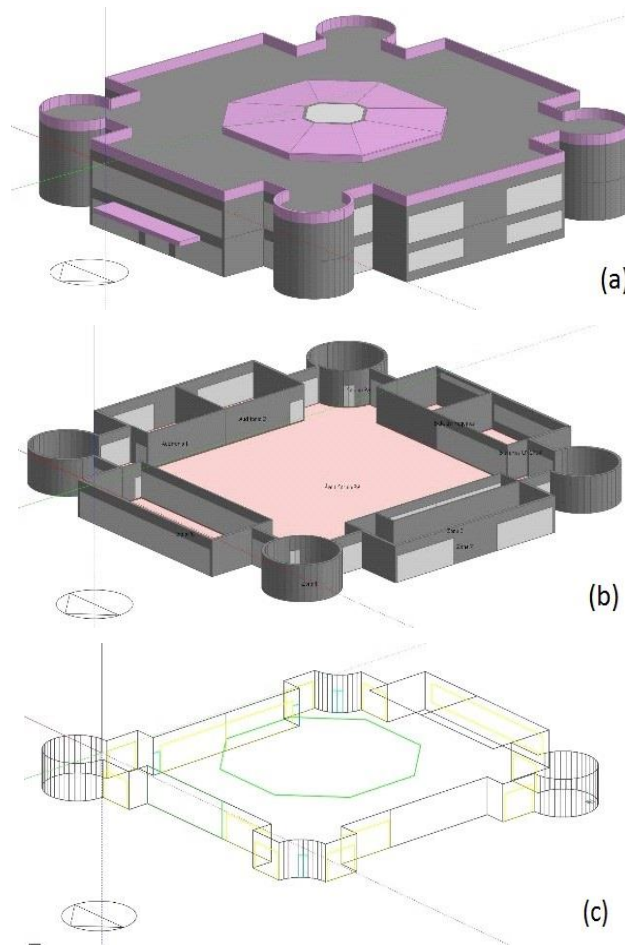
Geometría del edificio evaluado: (a) Envoltente, (b) Interior de planta alta, (c) Interior de planta baja.
